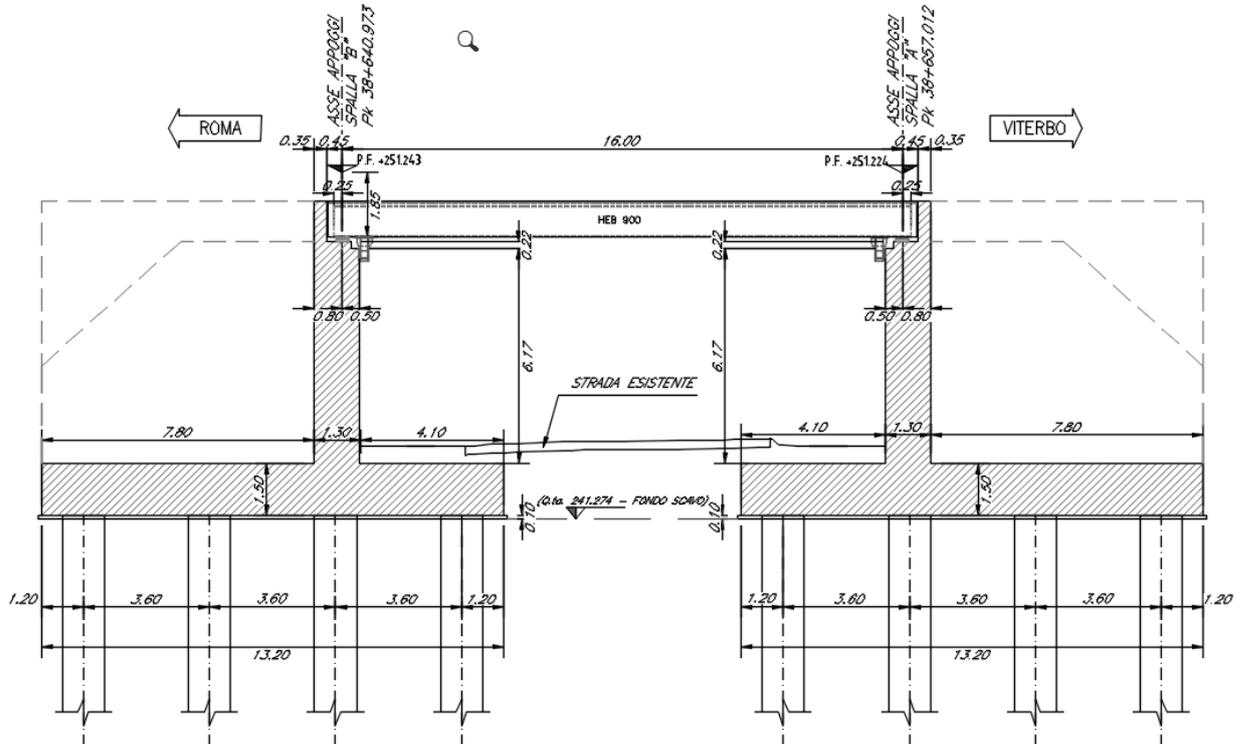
Ponte ferroviario VI01 al km 38+650: prospetto
